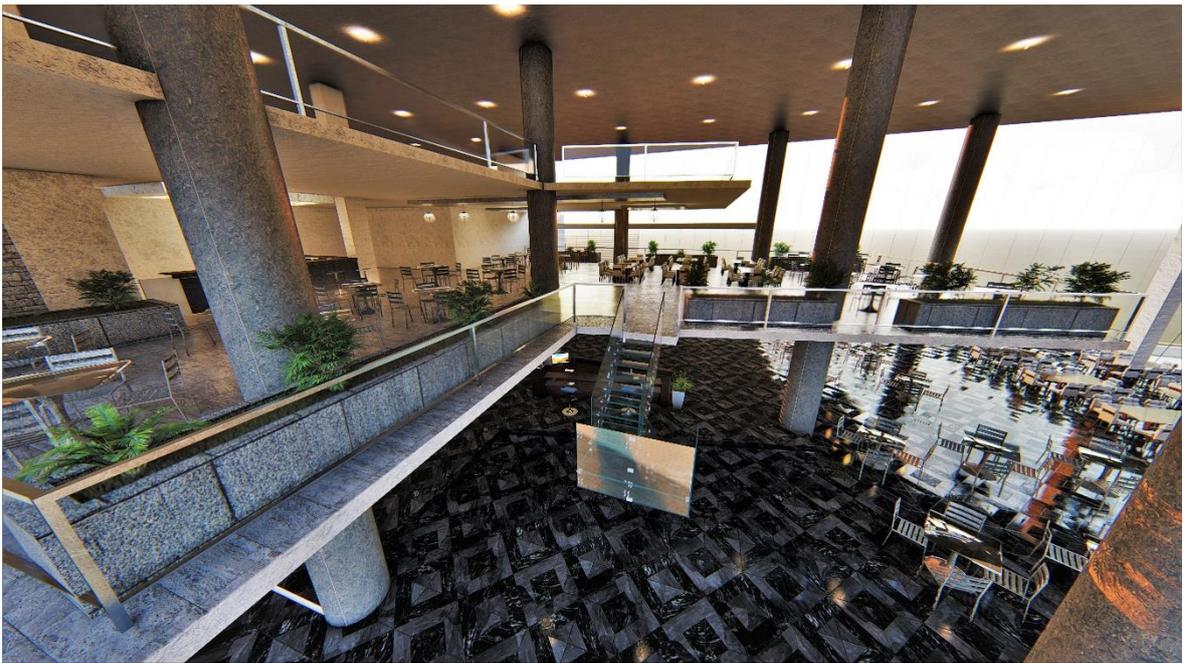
y 40: Vistas Interior del Proyecto – Restaurante
